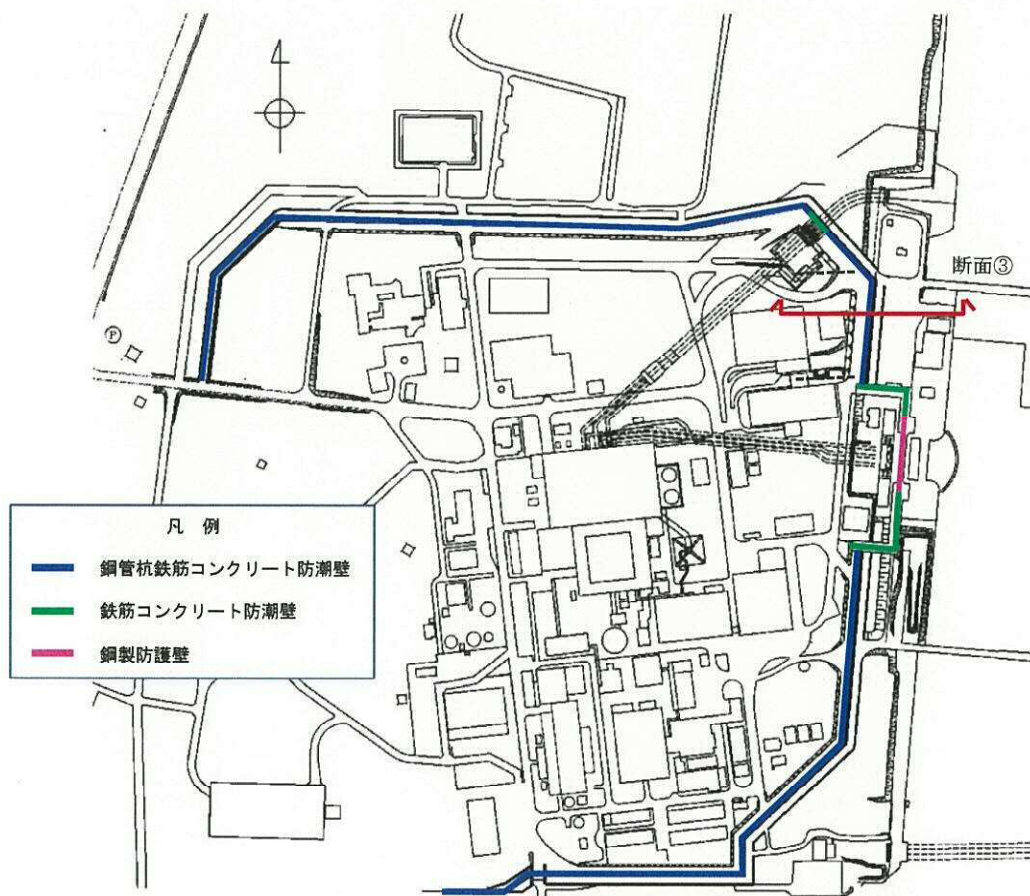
鋼管杭鉄筋コンクリート防潮壁の平面配置図（全体平面図）
